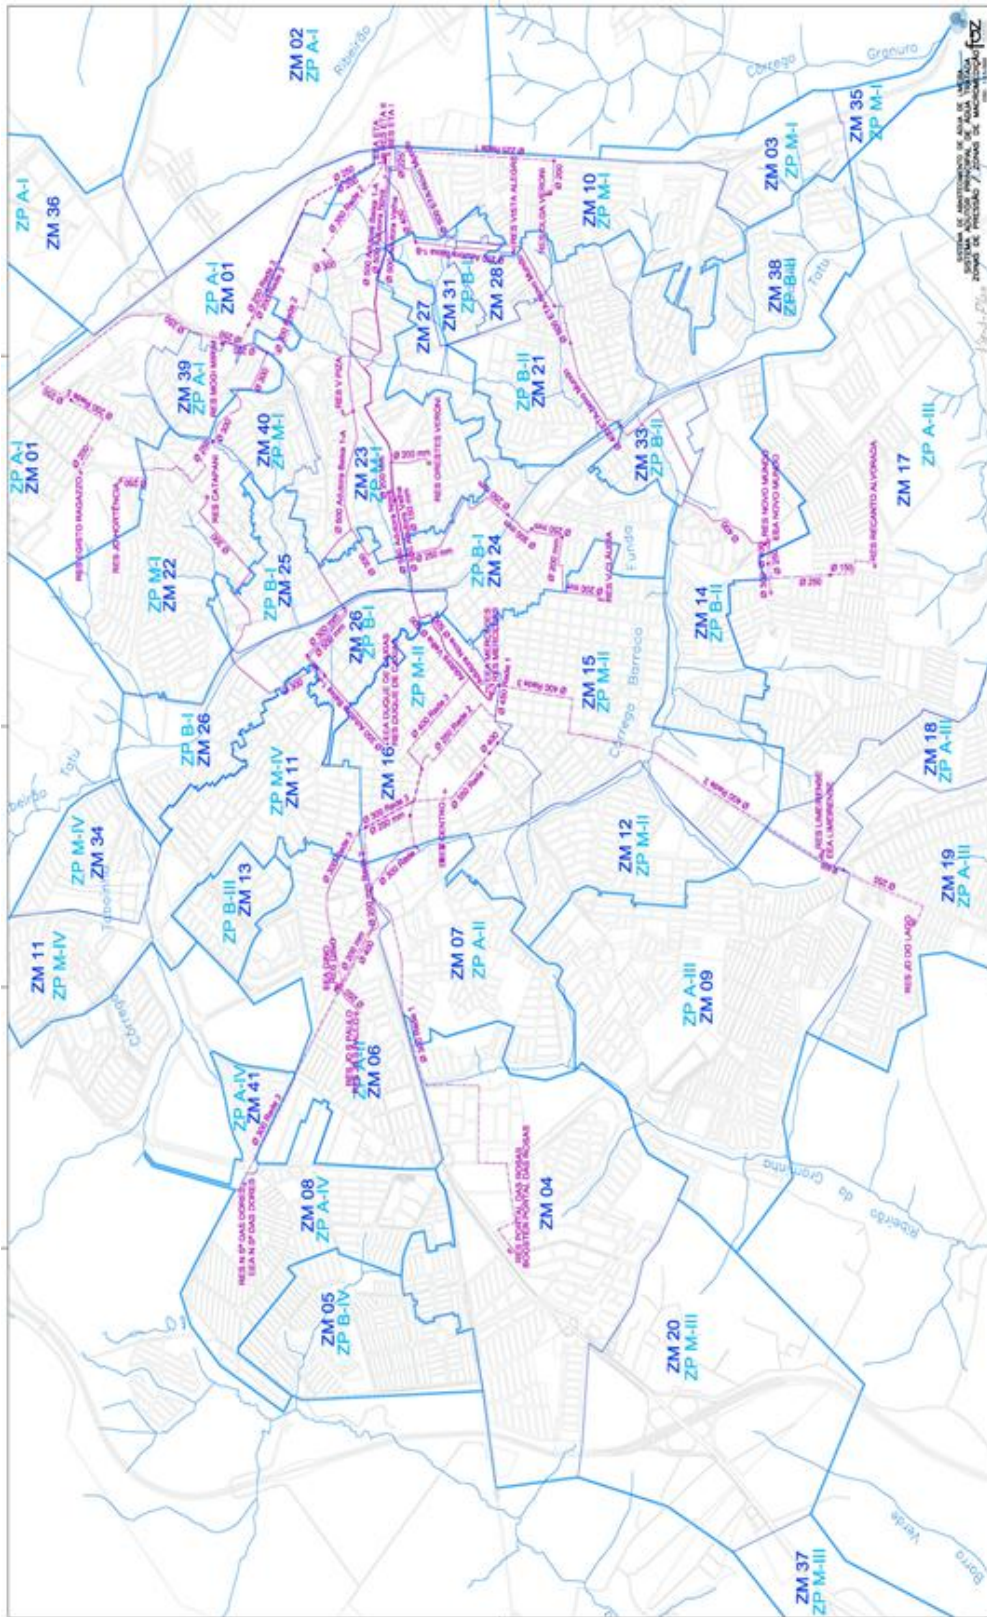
Planta de Localização das instalações de Adução de Água Tratada
